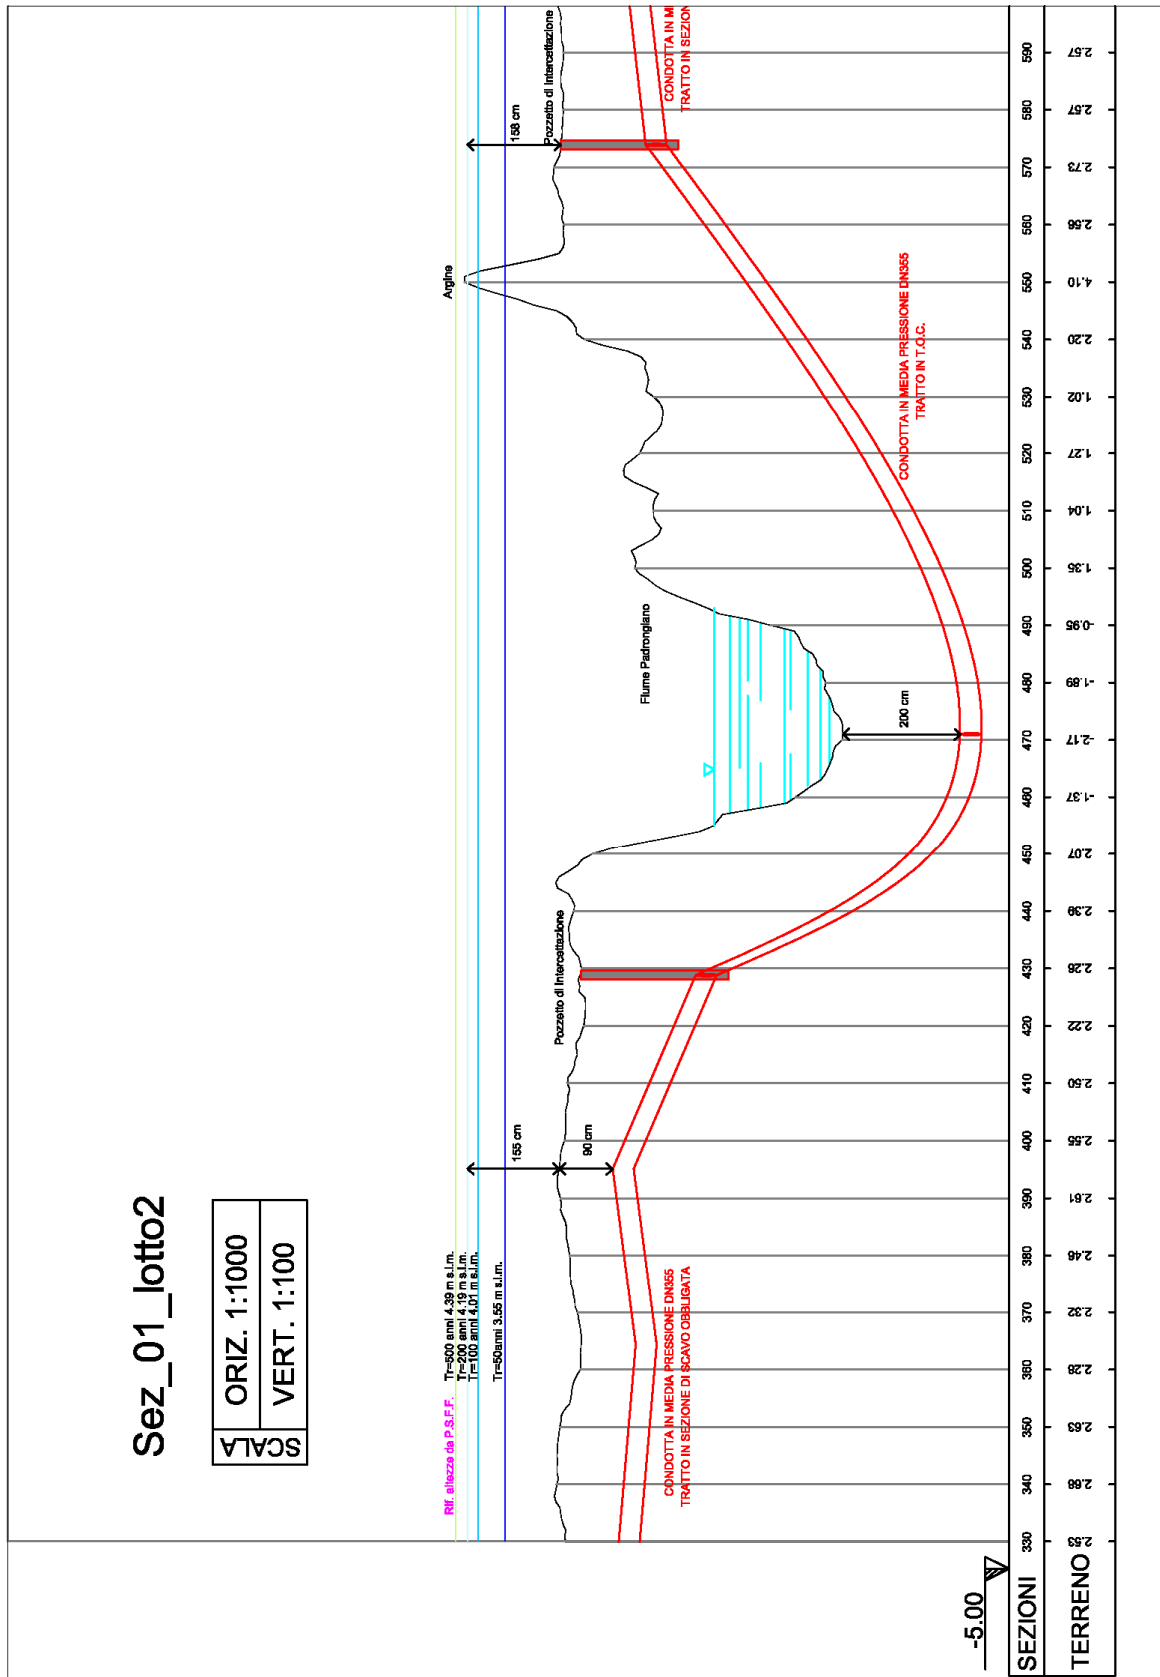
Sezione “Sez_01_lotto2”. Stralcio della sezione dell’attraversamento del Fiume Paringiano.
